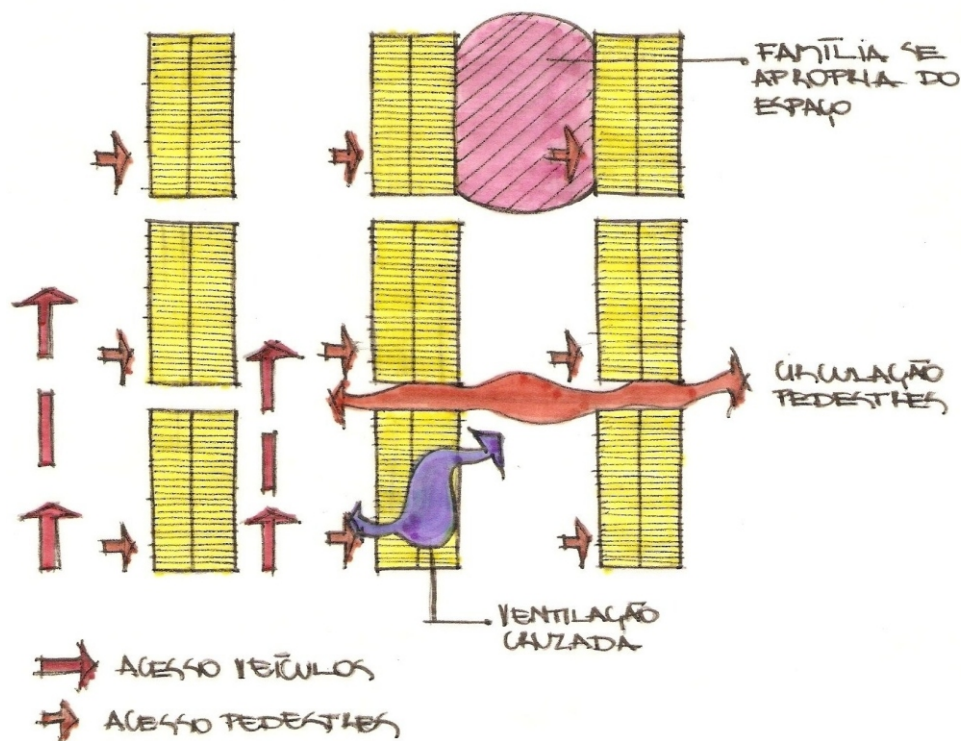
Planta Baixa. Assentamento Provisório Haiti.
